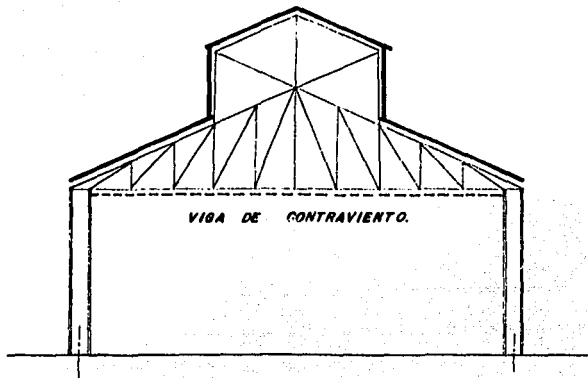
Disposición de la armadura de contraviento en la cuerda inferior de la armadura de techo.
